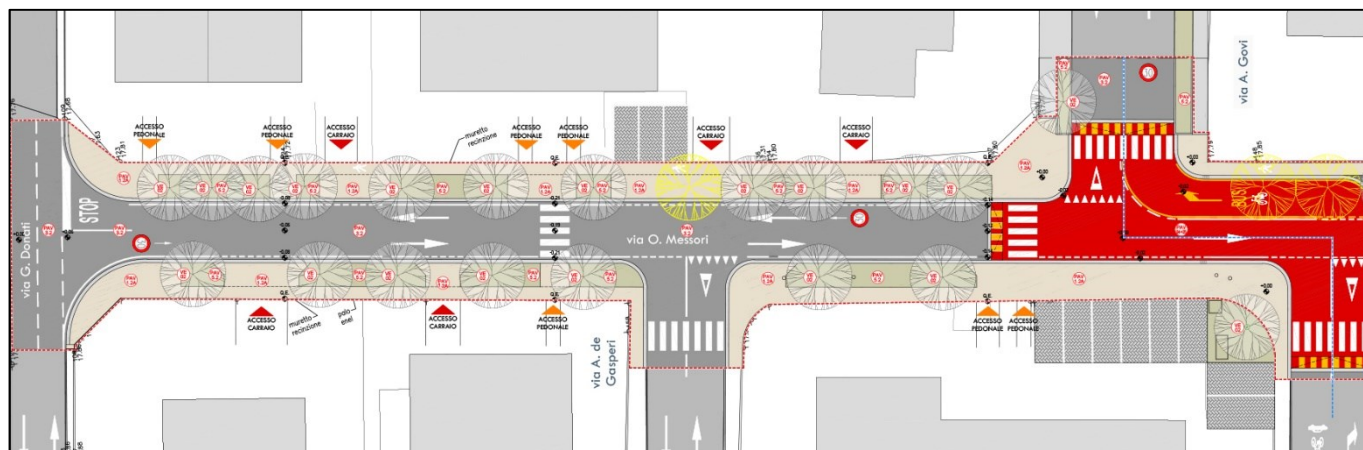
elaborato di progetto - stralcio d'intervento n°1
